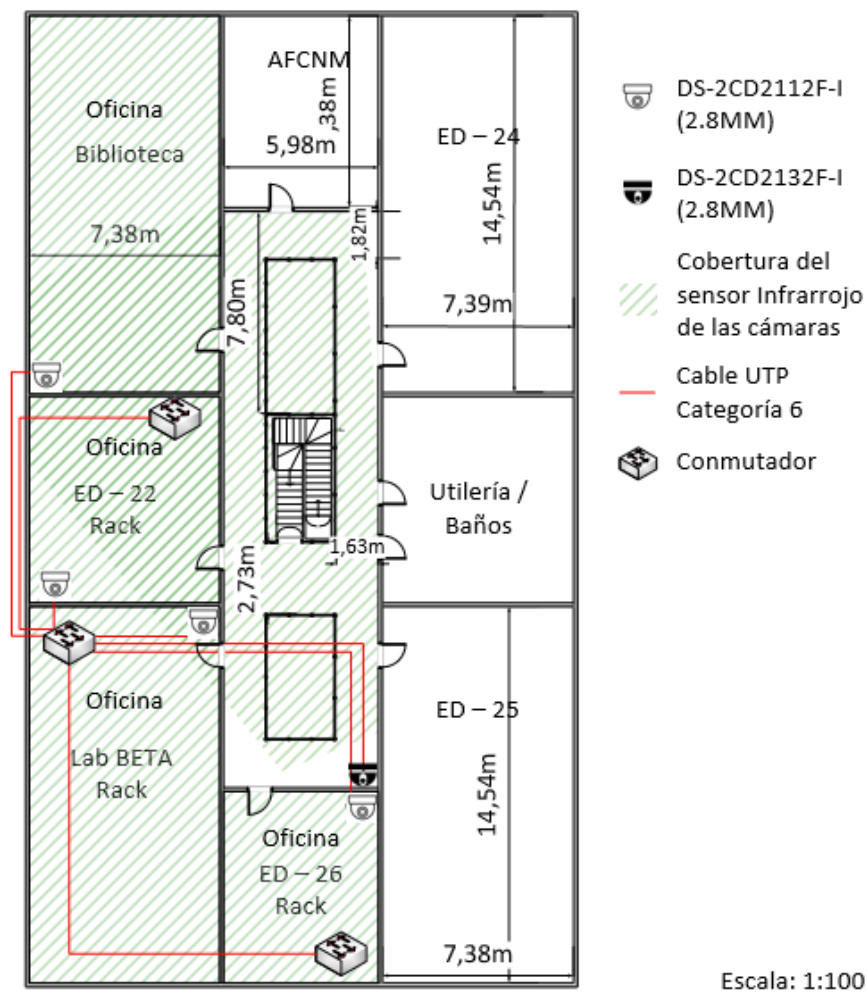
Ubicación de las cámaras el edificio 32 D, primer piso.
